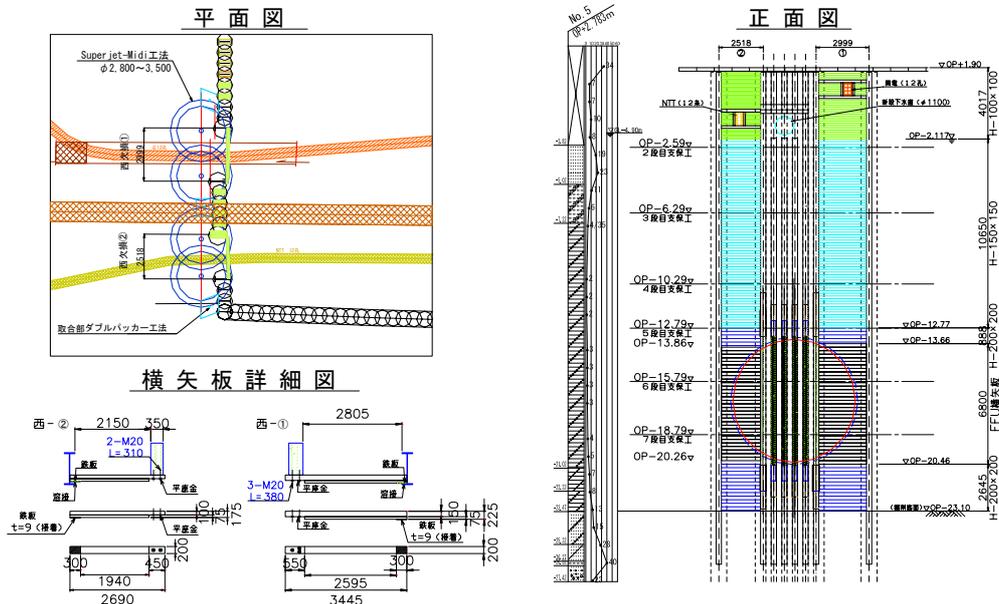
土留め欠損部平面・断面図(渡辺橋駅 西側立坑部)
